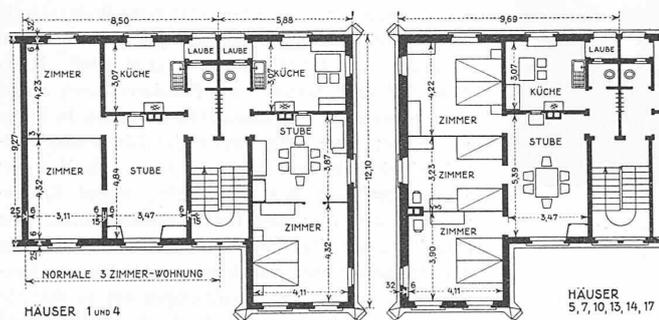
Grundrisstypen im Erismannhof. — 1 : 300.
